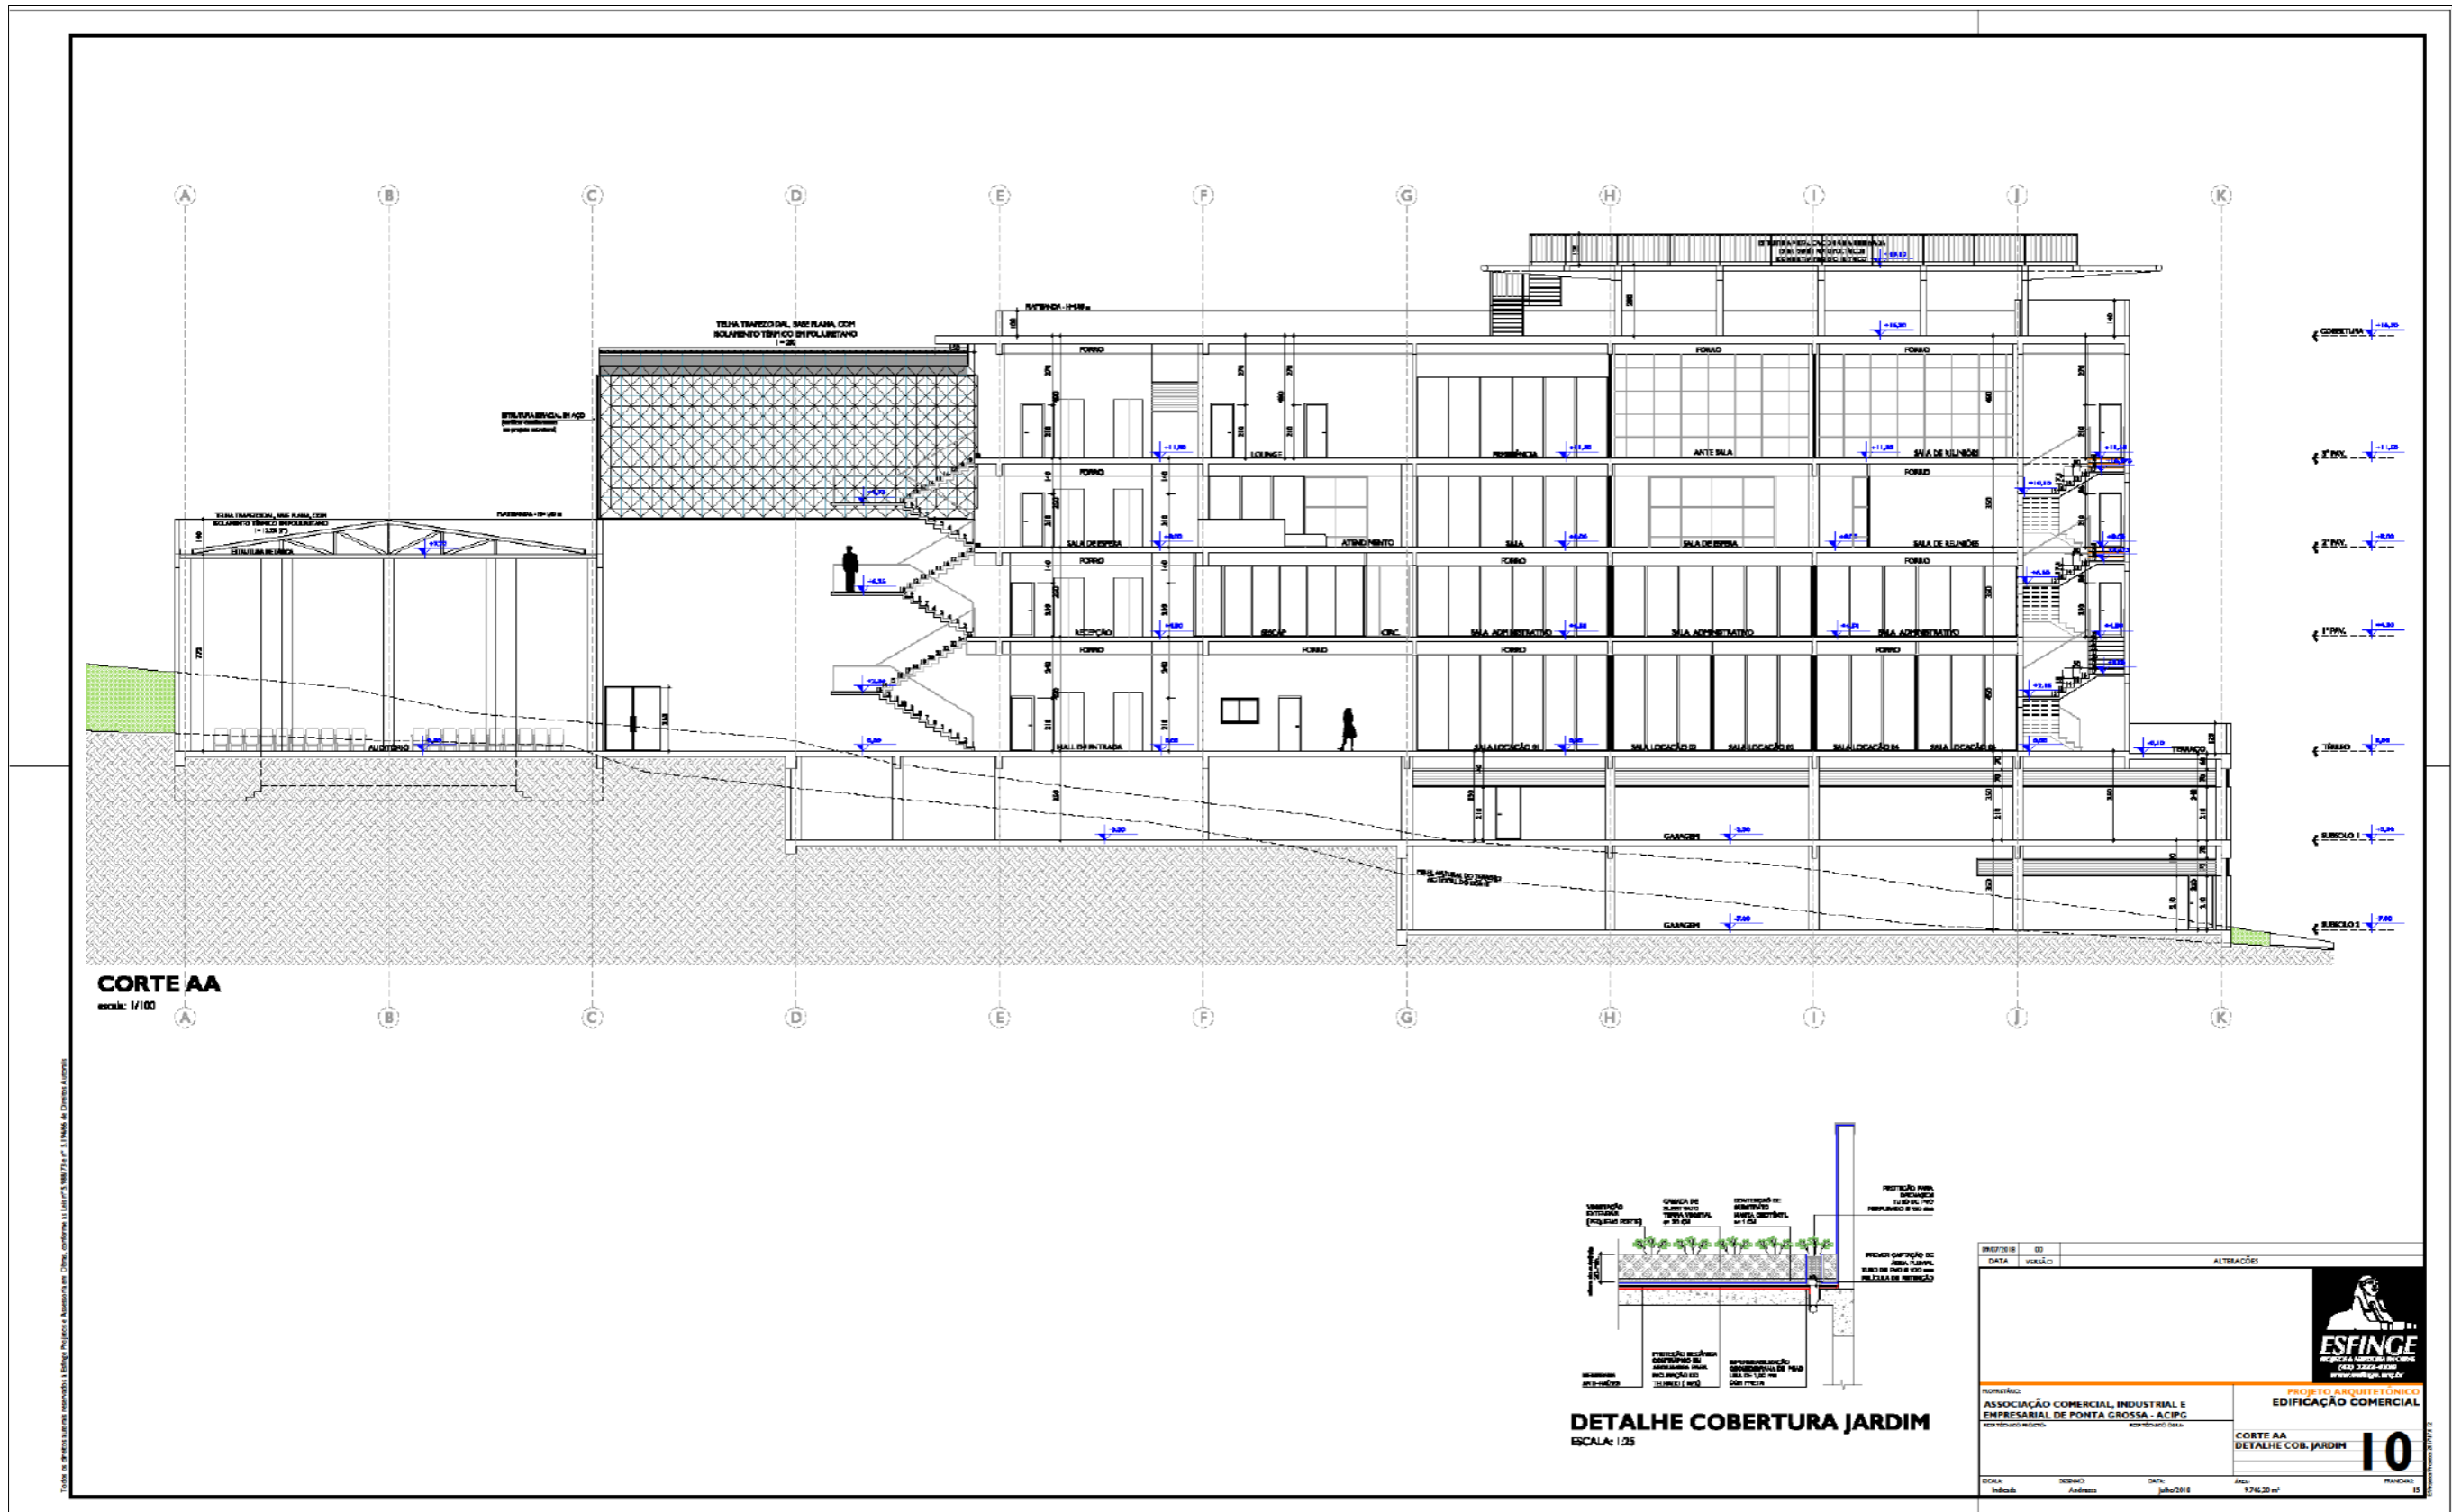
Corte AA e detalhe de cobertura. Fonte: Esfinge Arquitetura e Engenharia (2018).
